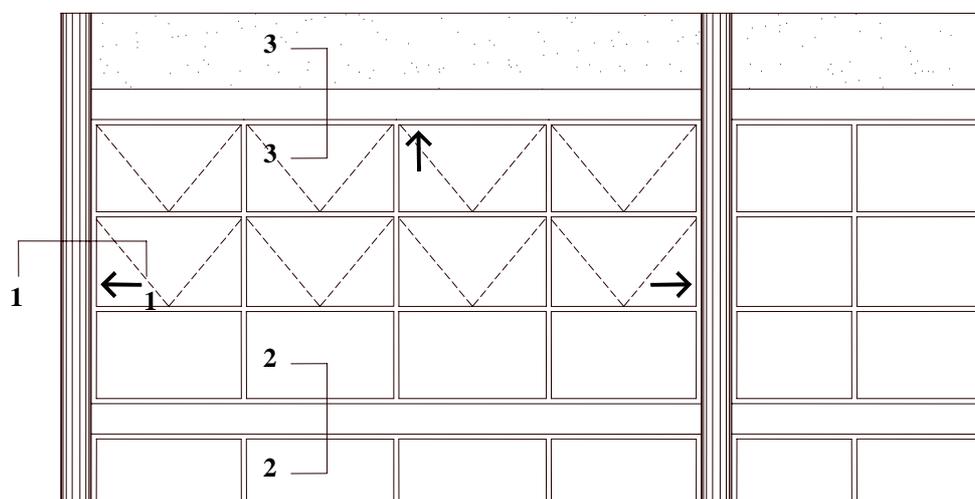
Elevação típica de um painel de vedação em vidro encaixilhado.
